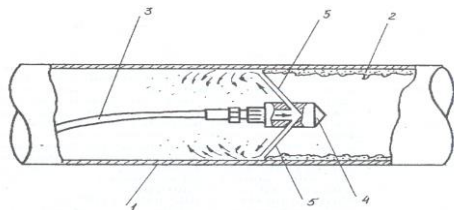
Гидромониторный способ очистки труб: 1 - стенка трубопровода; 2 - внутритрубные отложения; 3 - гибкий шланг высокого давления; 4 - насадка с отверстиями; 5 - очищающие струи воды.
